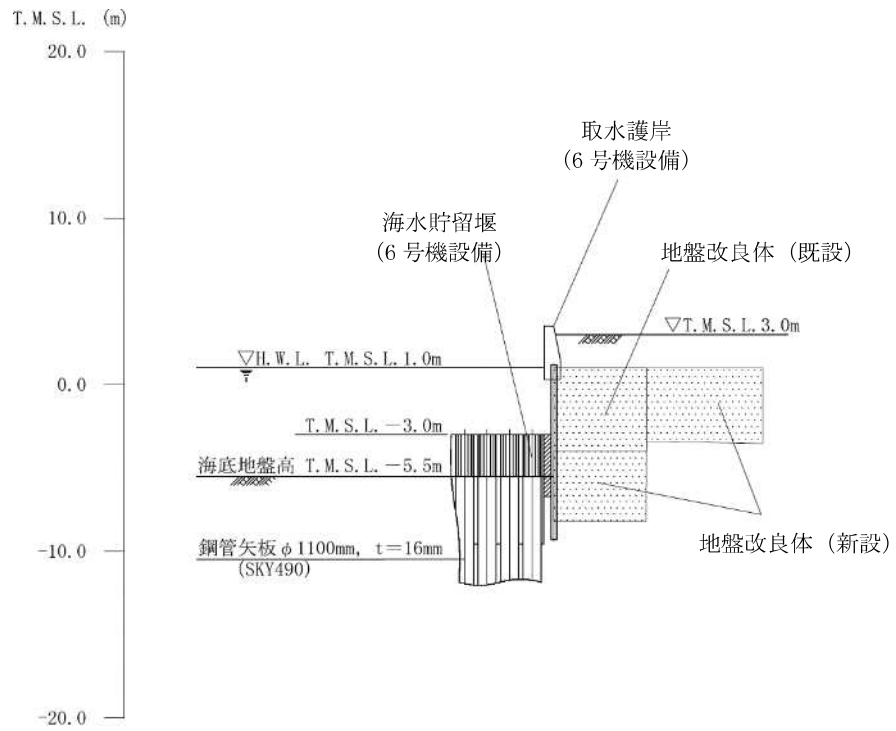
取水護岸 (6号機設備) の標準断面図 (A-A断面)
